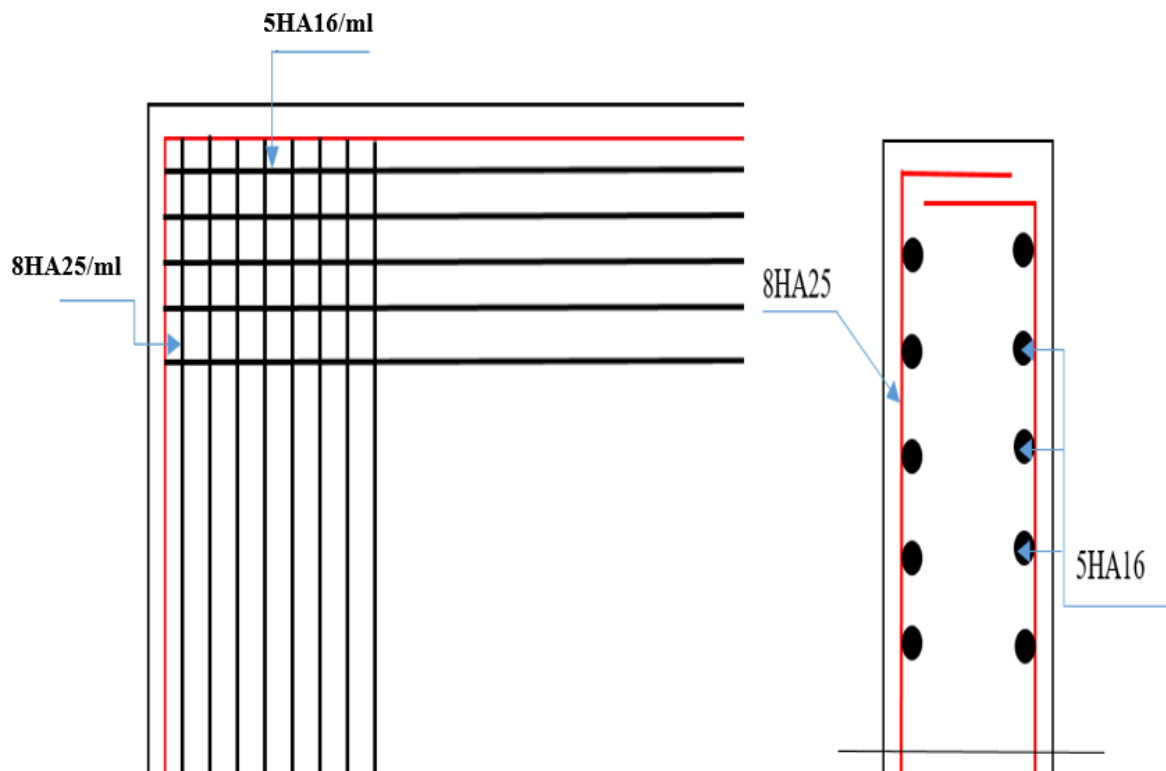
FERRAILLAGE DU MUR FRONTAL
